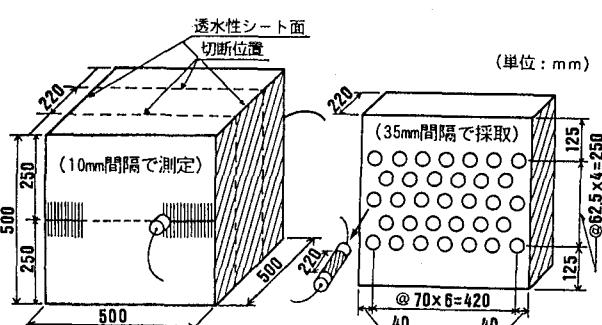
供試体の形状と超音波測定位置 図-3 コアの採取位置
